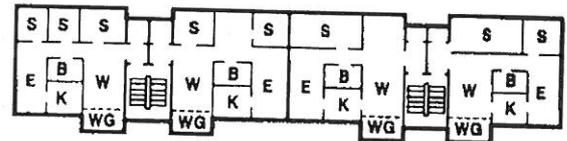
Terrassenhaus, Haus mit Staffelgeschossen
